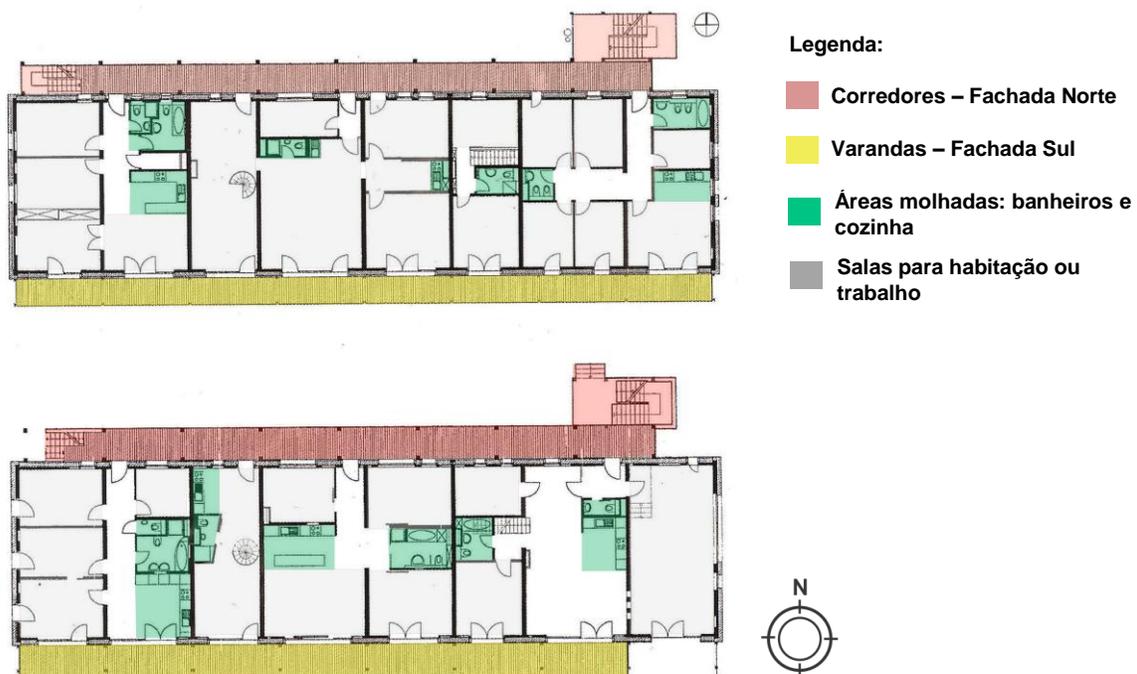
, 118 – Planta Baixa de dois pisos padrão.
